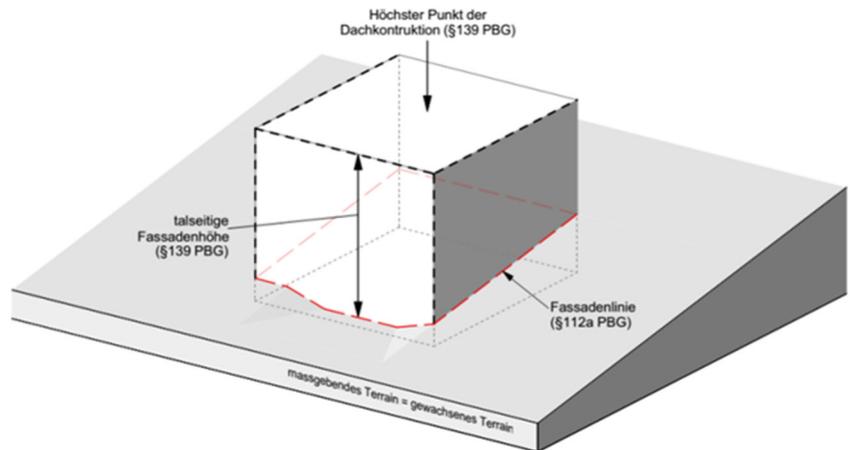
Talseitige Fassadenhöhe und höchster Punkt der Dachkonstruktion
